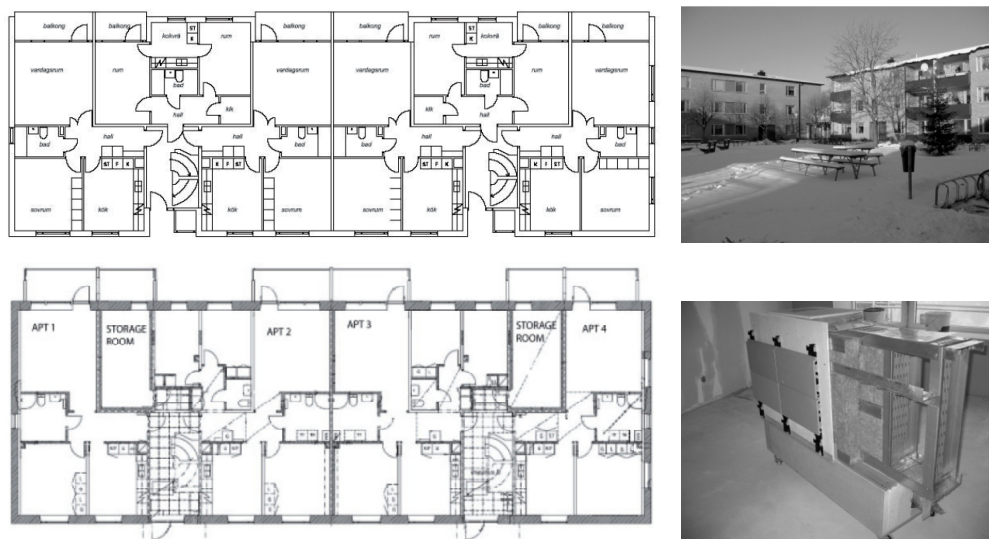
Apartamentos en Brogårdén-Alingsås, Suecia. Planta estado original, planta reformada, imagen exterior y solución de fachada en la renovación [JANSON 2010].
